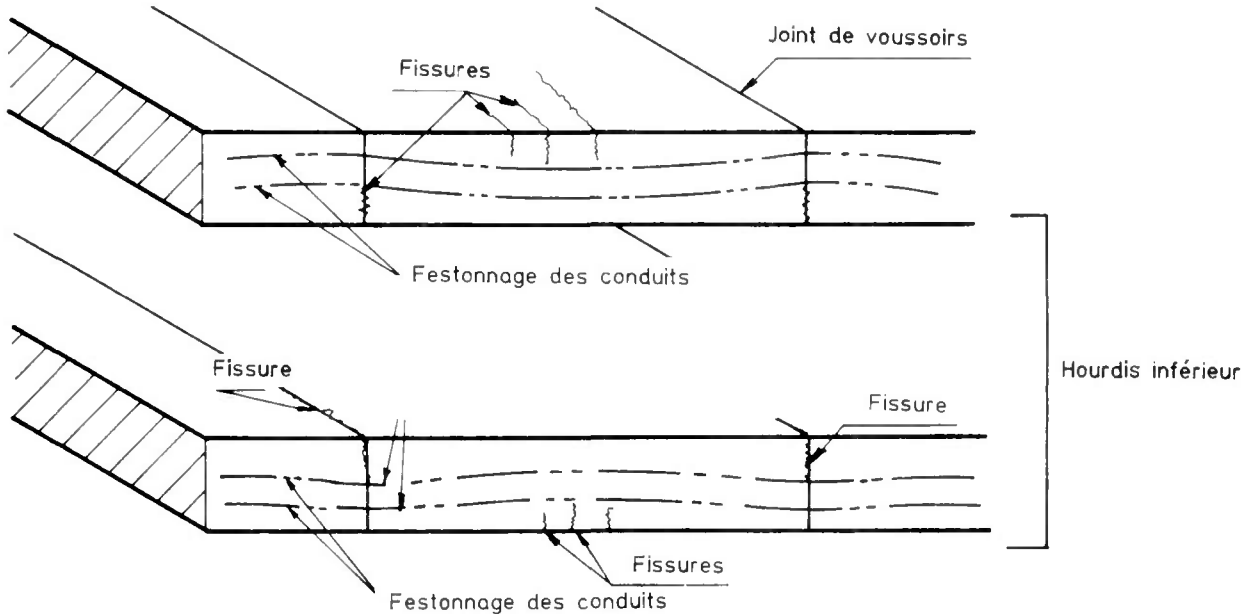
Fissures dues au festonnage des conduits.
